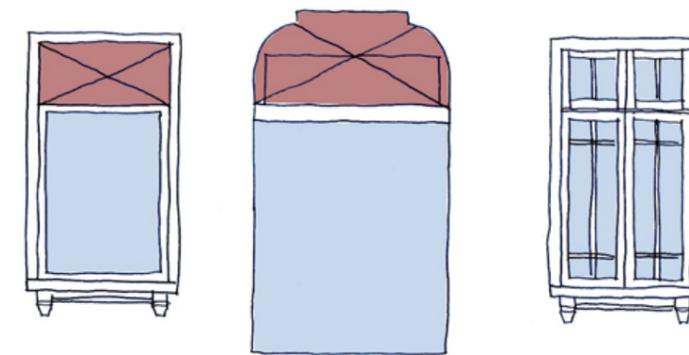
Croquis de vanos tipo de Av. Matta. En rojo zona para soporte publicitario. Fuente: elaboración autores.
